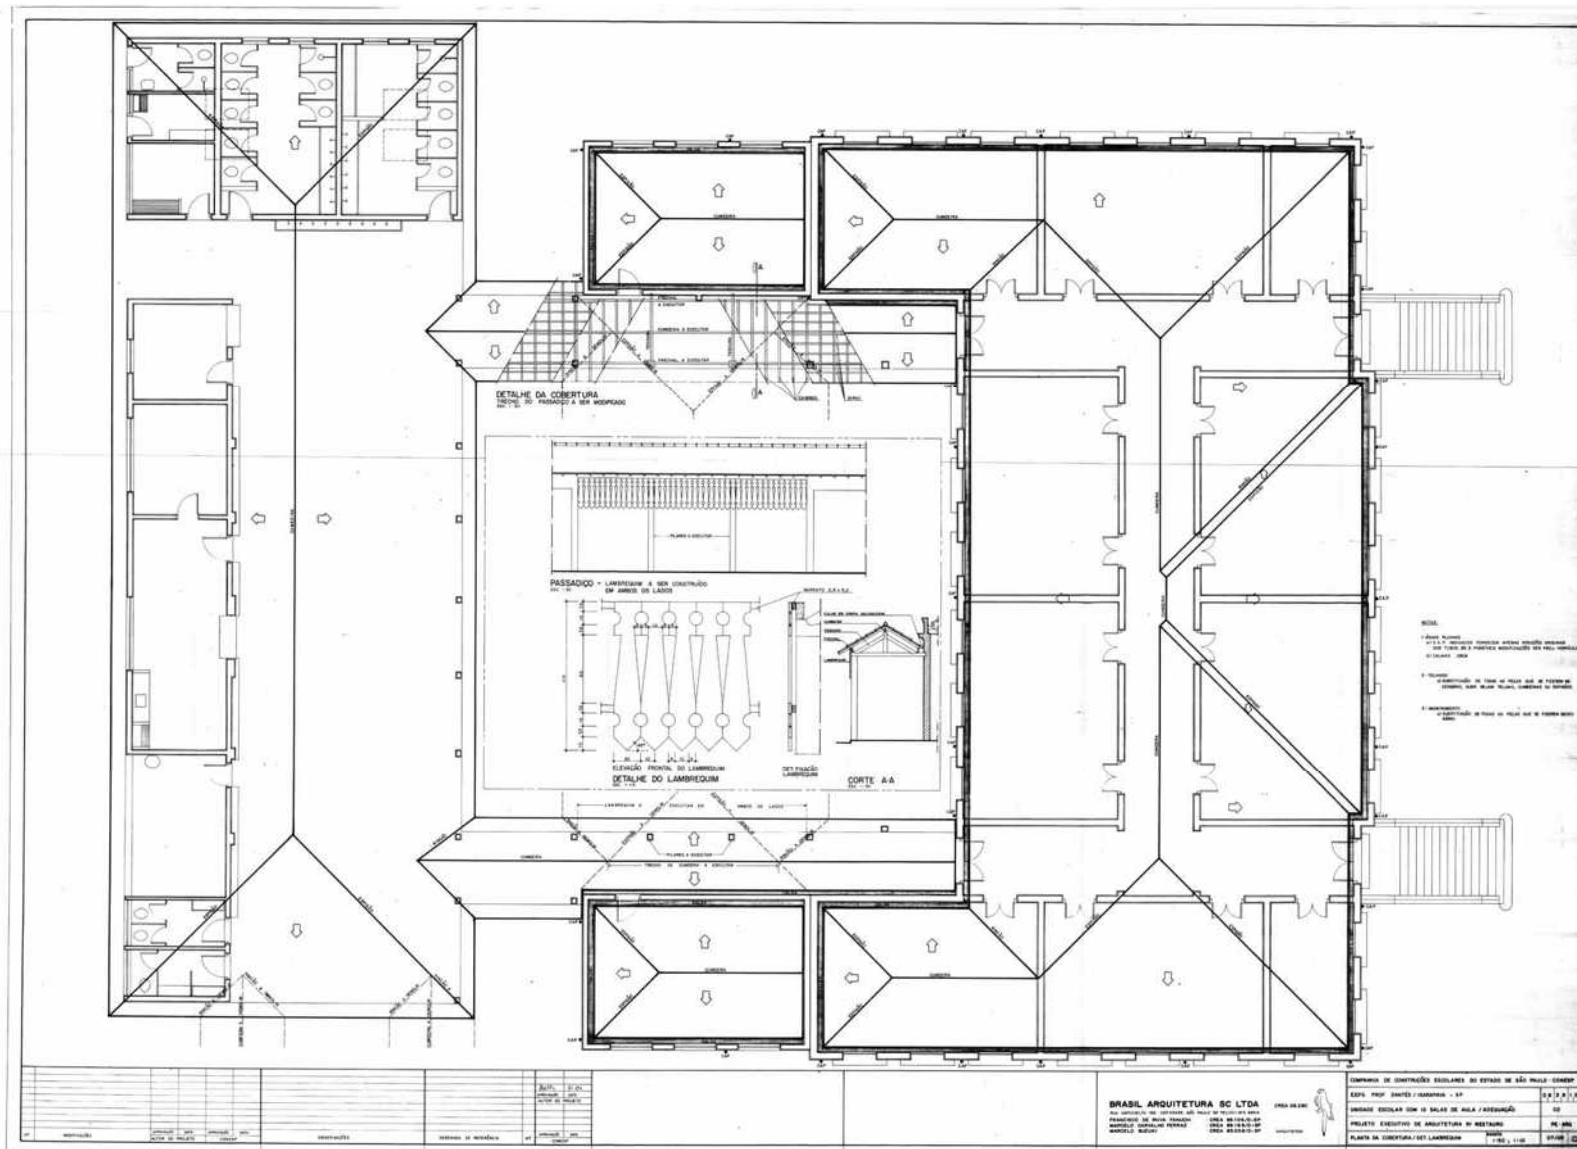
Planta da Cobertura – proposta de intervenção na escola Prof. Dantes. Fonte: arquivo do FDE.
